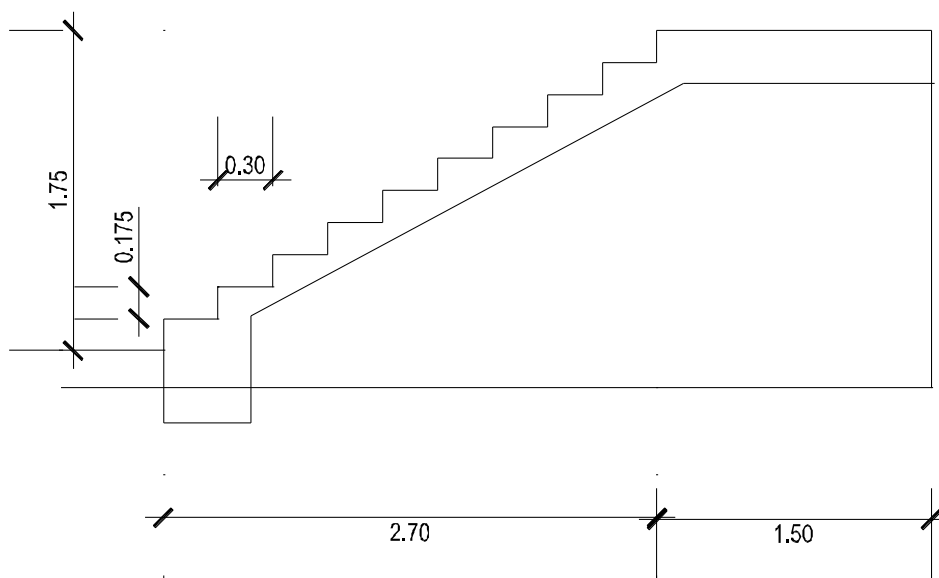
51 VISTA FRONTAL DE ESCALERAS
